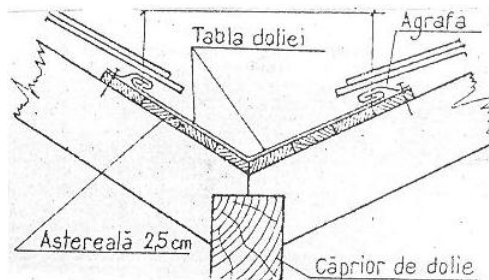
Anschluss der Dachdecke zur Dachkehle
